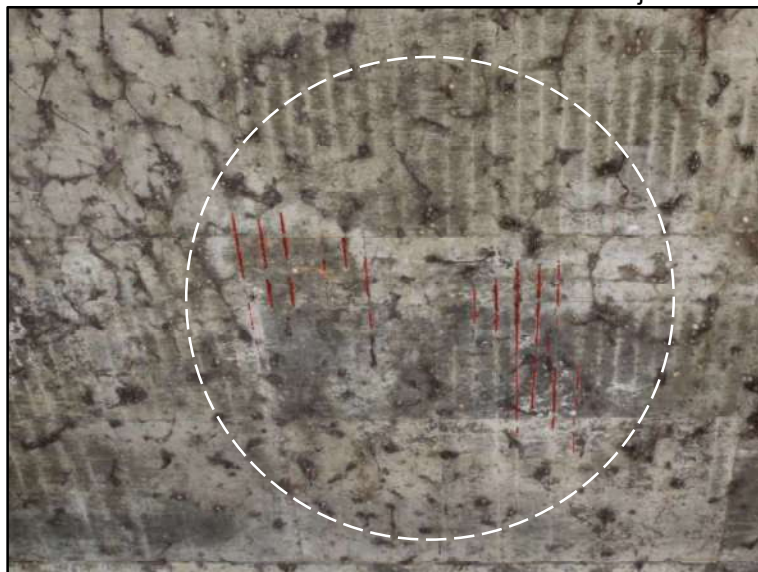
Fissuras na laje do tabuleiro.
